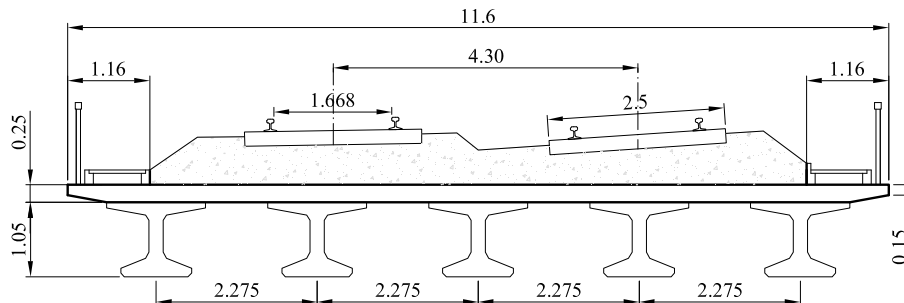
Sección transversal recta del puente Arroyo Bracea. Unidades (m)
